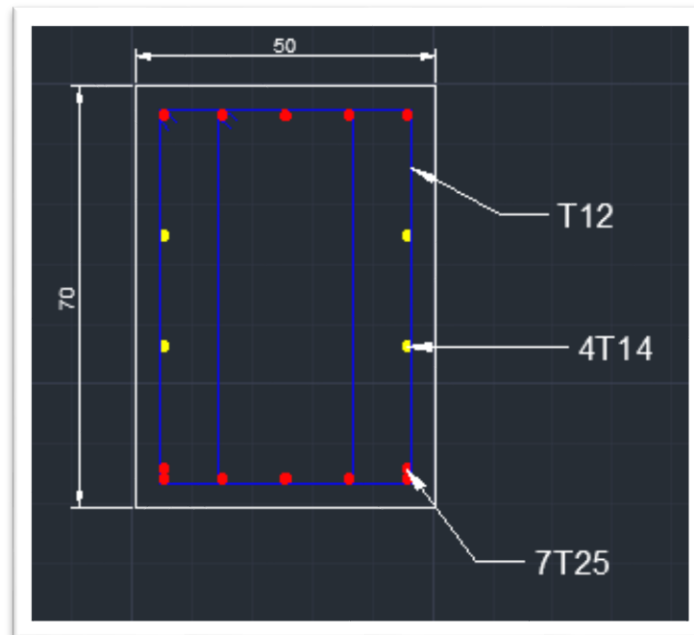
Schéma du ferrailage de la poutre nervurée
